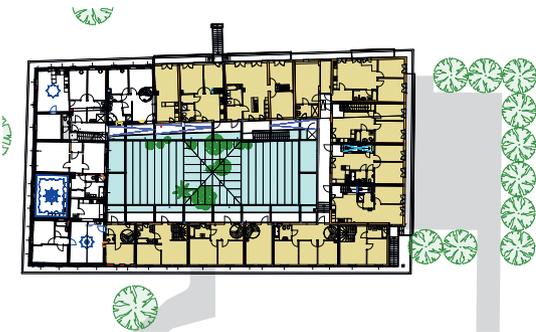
| Genawo. Grundriss 1. Obergeschoß
